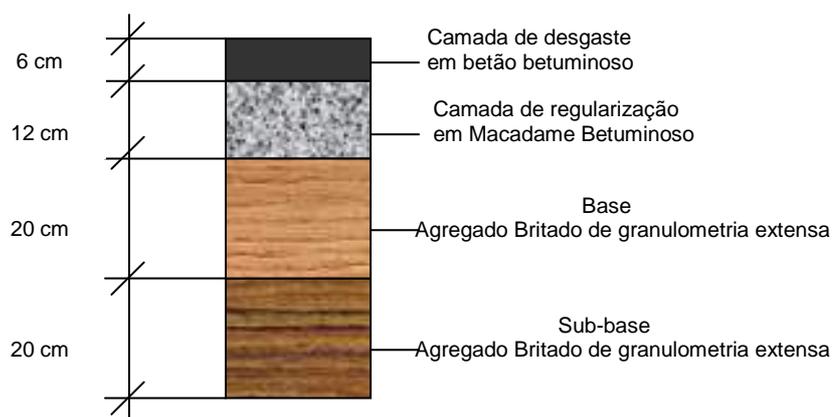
Estrutura inicial do pavimento (IC12 – Canas de Senhorim/IP3)
